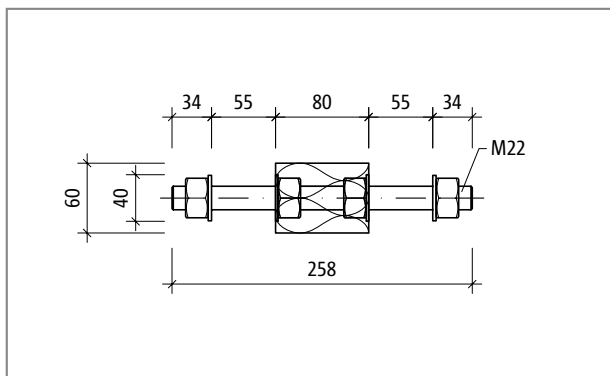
Schöck Isokorb® T tipo S-N-D22: sezione dell'elemento
